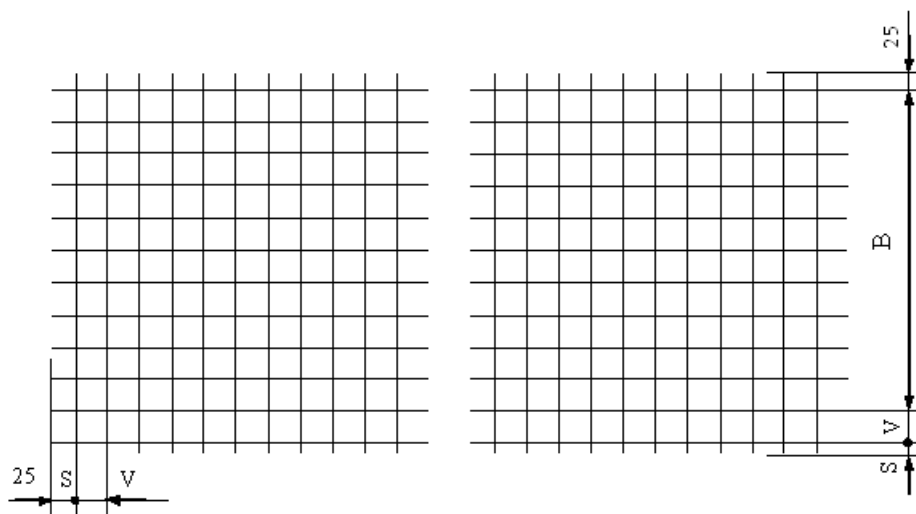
Сварная металлическая сетка, используемая в конструкциях из ненапряженного железобетона
